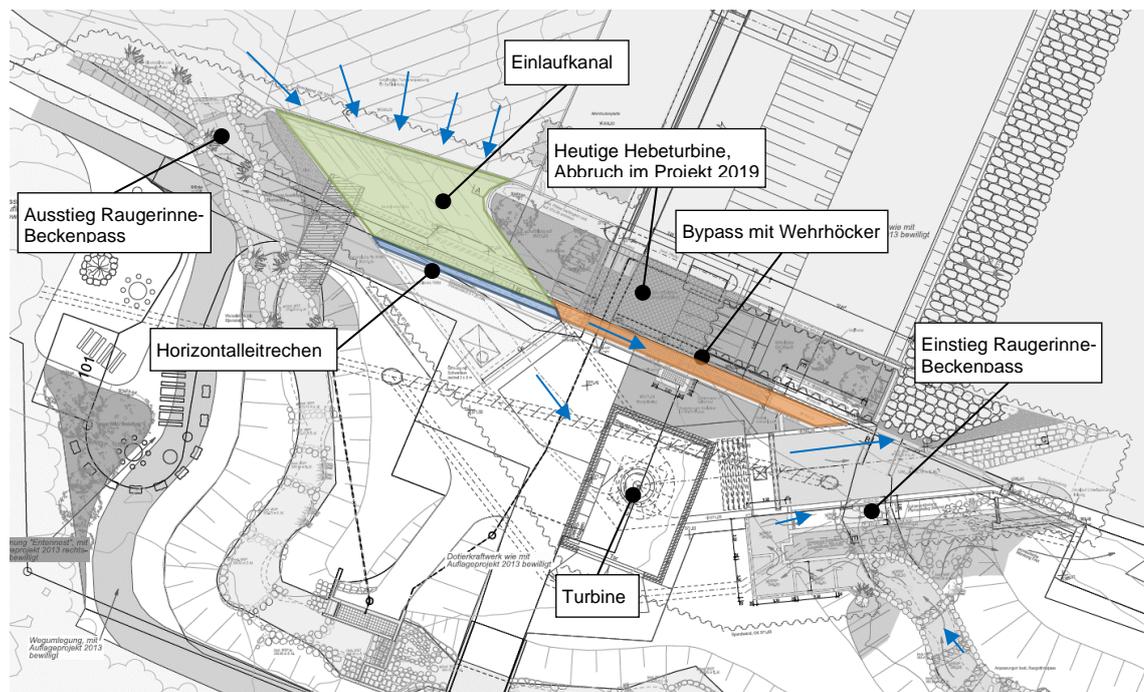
Fischabstieg: Einlaufbereich (in grün), Horizontalleitrechen (in blau) und Bypass (in orange) (Auszug Plan P.33N.044, IUB 2019)
